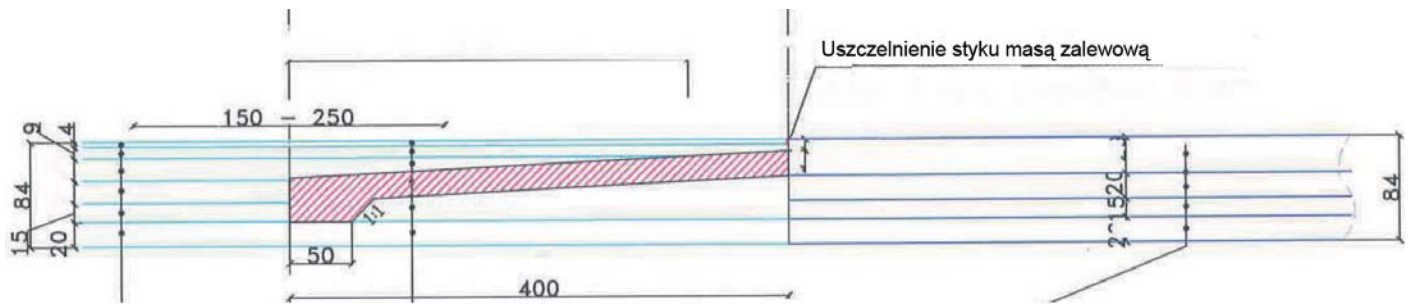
Żelbetowa betonowa płyta monolityczna, zbrojona, o zmiennej grubości, wykonywana na mokro, zagłębiająca się w formie klina pod pakiet warstw asfaltowych [8]
